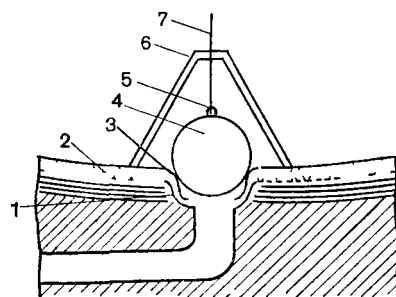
Устройство затвора для перекрытия выпускной трубы из круглого бассейна.
